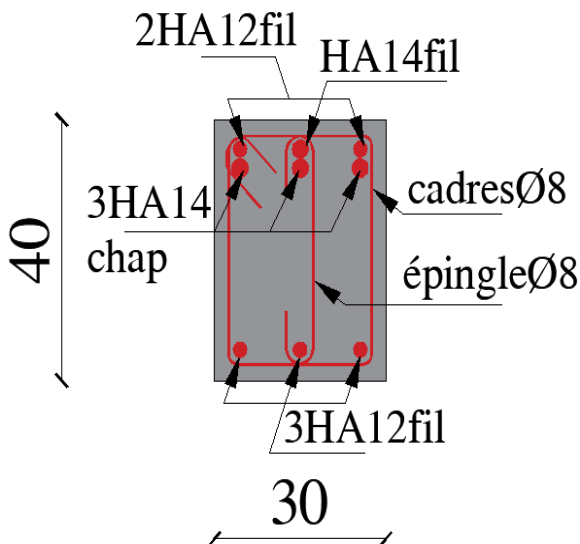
Schéma de ferrailage de la poutre principale renforcée
